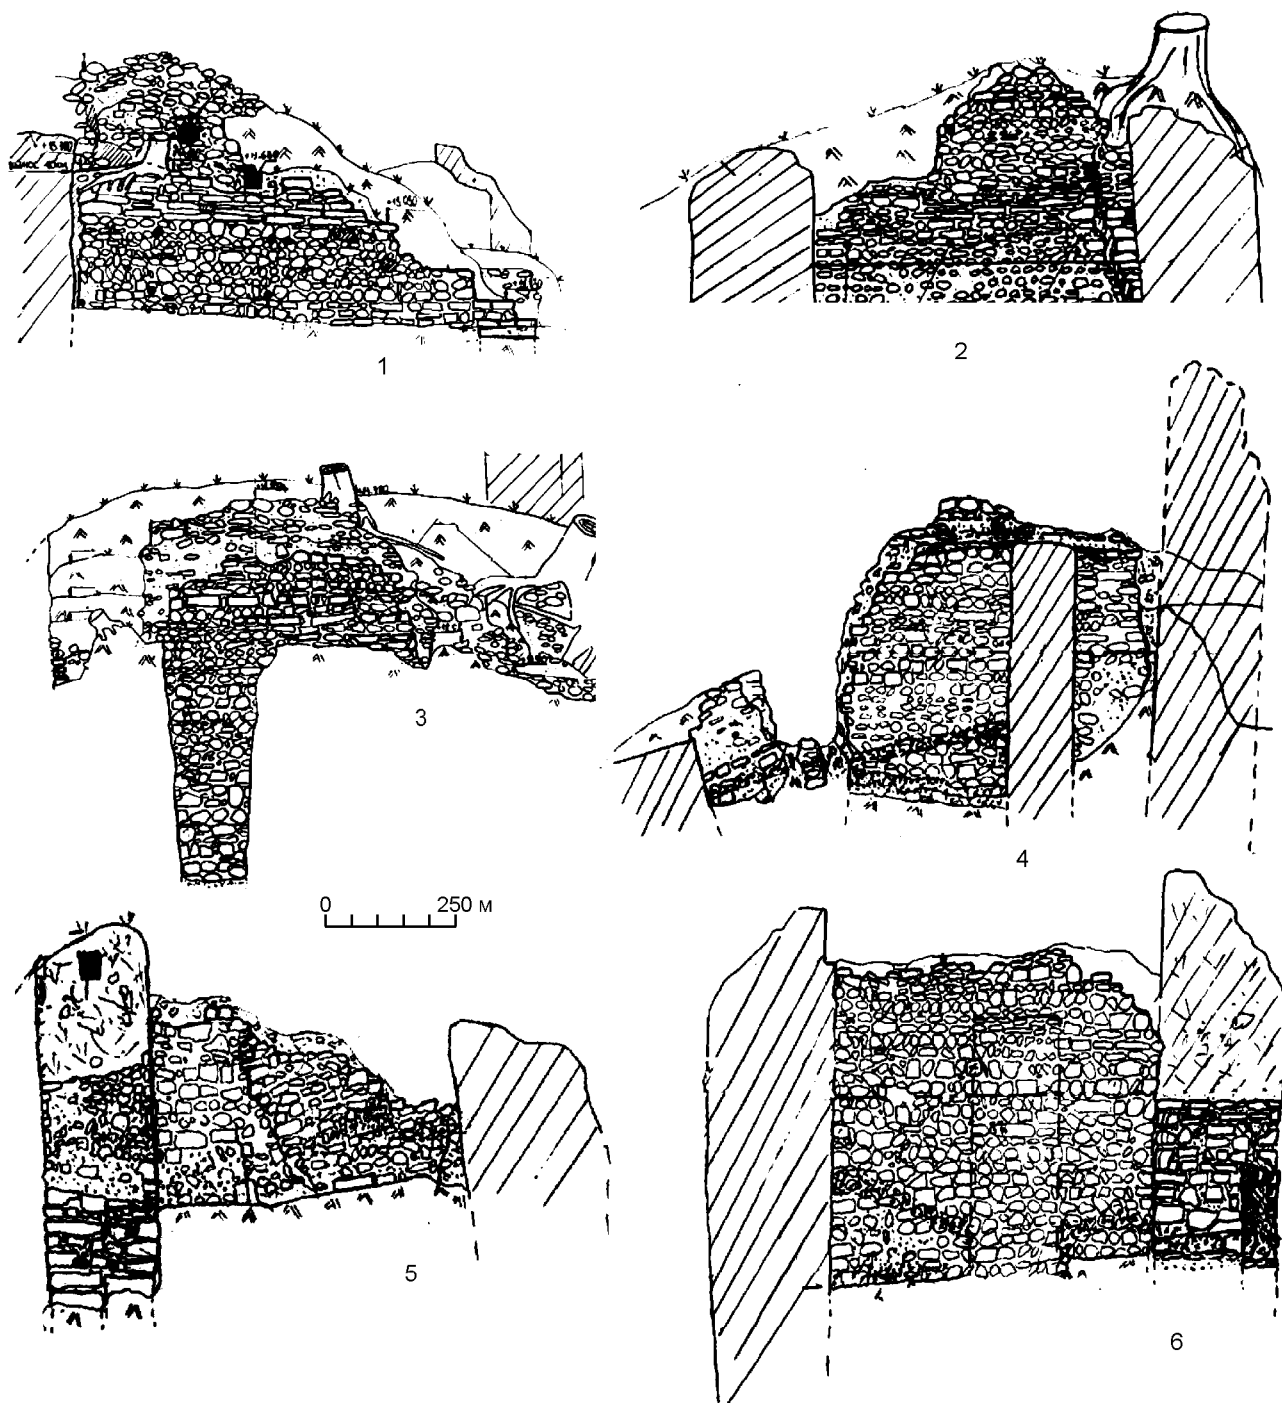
Крепость Годлик. Башня III: 1 — фасад южной стены; 2 — южная стена, вид с севера; 3 — фасад восточной стены; 4 — восточная стена, вид с запада; 5 — северная стена, вид с юга; 6 — поперечная стена внутри башни, вид с севера
